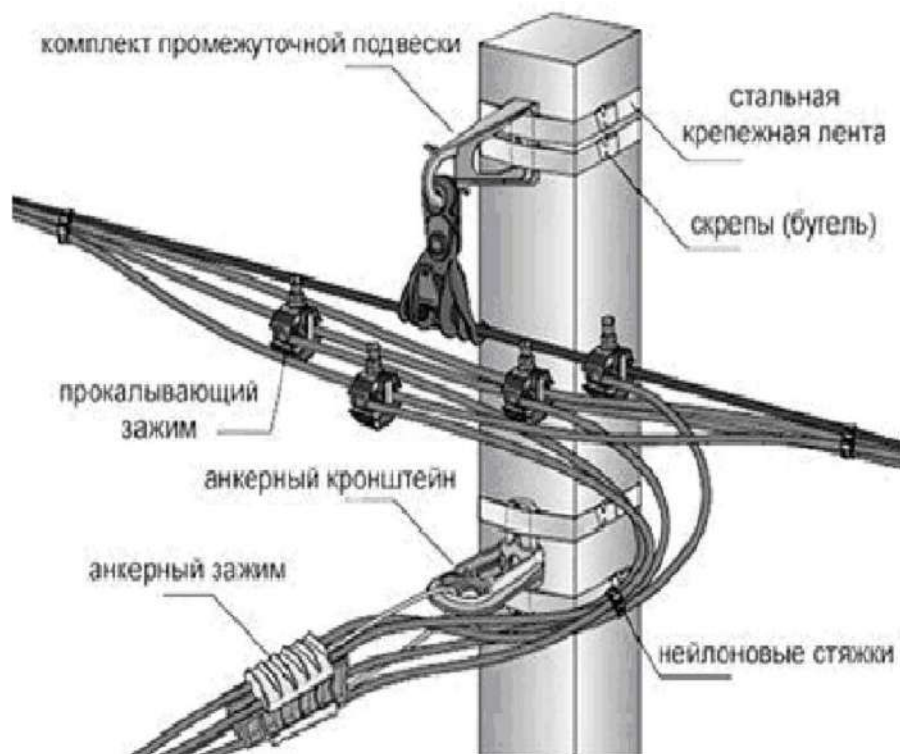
Пример крепления провода СИП на железобетонной опоре.
